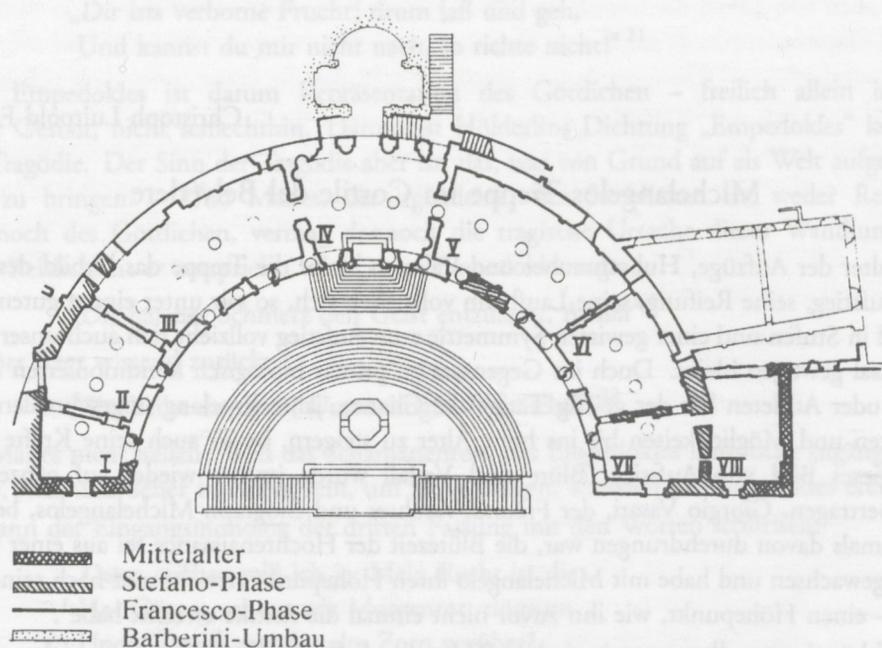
Palestrina, Palazzo Baronale, Grundriß der Exedra mit Treppe
